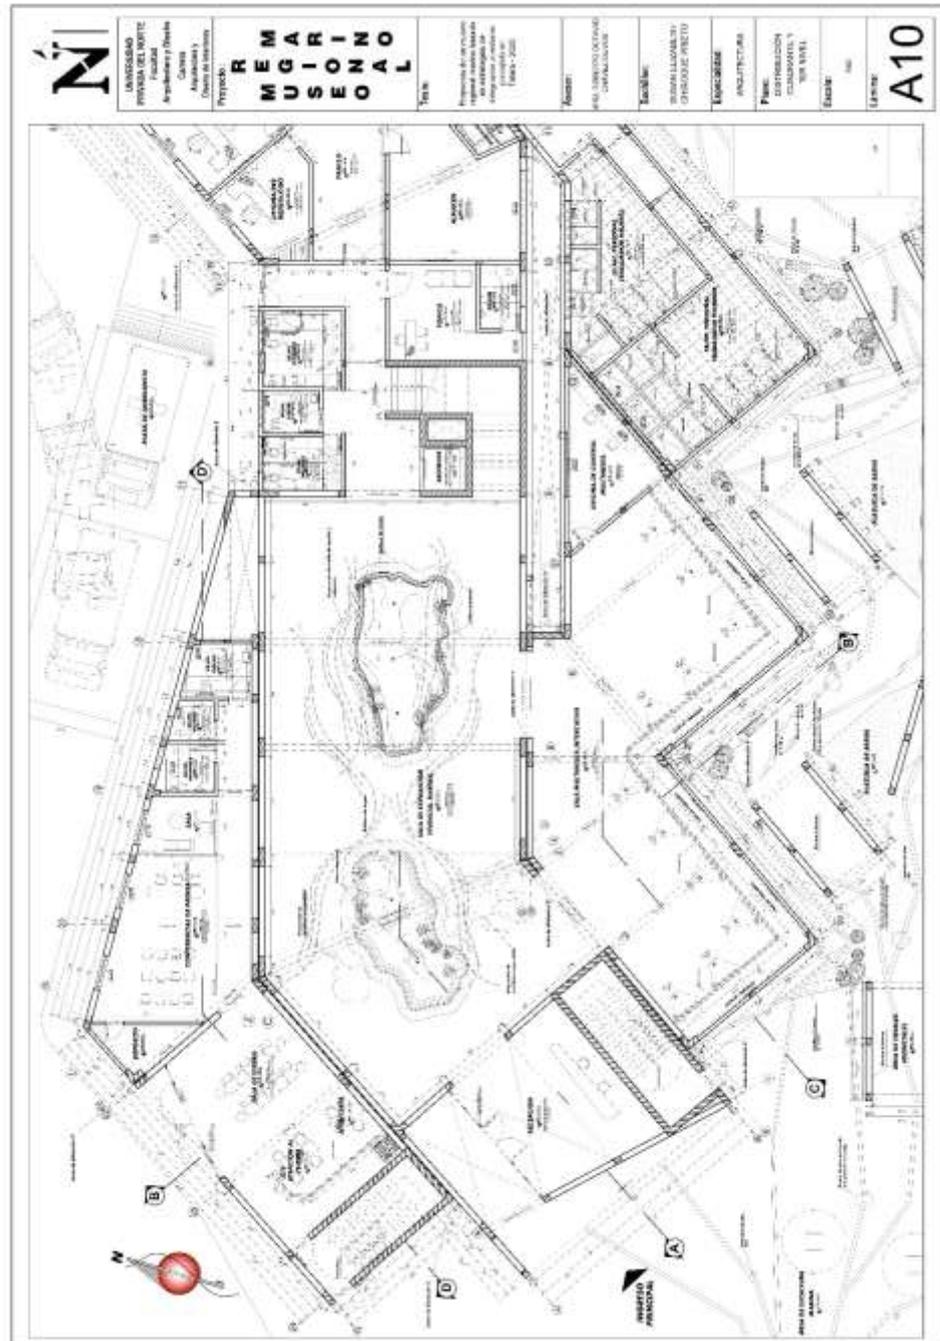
Distribución a detalle sector primer nivel primer cuadrante.
